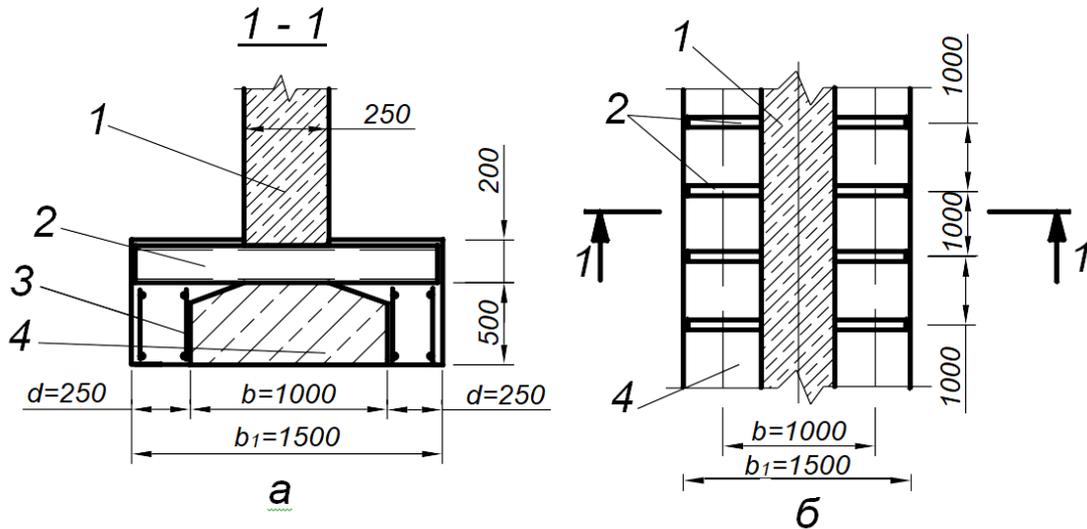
Усиление ленточного фундамента: а — сечение 1-1; б — фрагмент плана усиленного фундамента; 1 - кирпичная стена; 2 - траверса из двух швеллеров; 3 — каркасы дополнительных фундаментных полос из бетона; 4 - существующий фундамент
